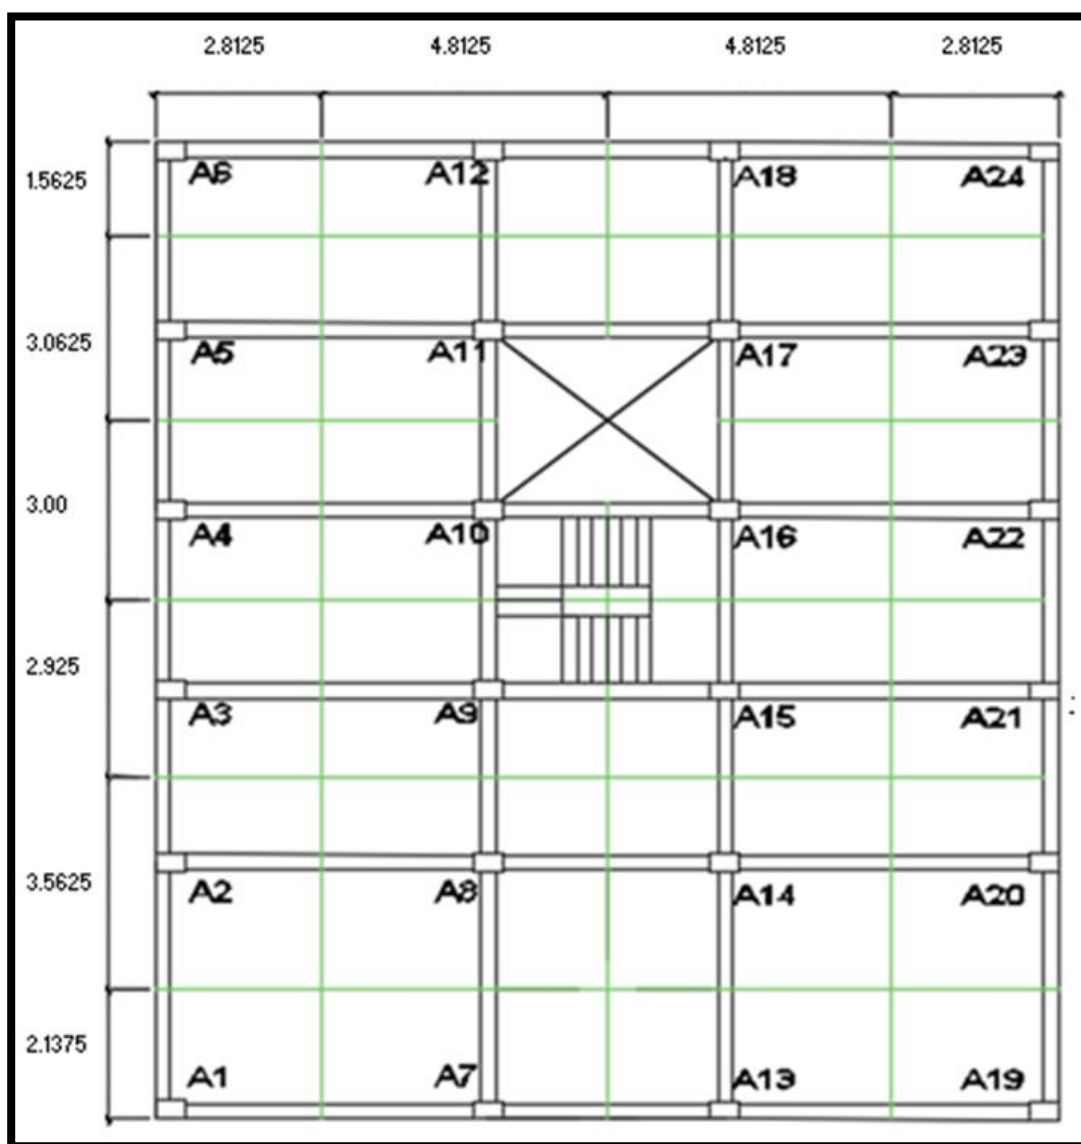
Señalización de áreas tributarias de las edificaciones en estudio. Planta típica.
